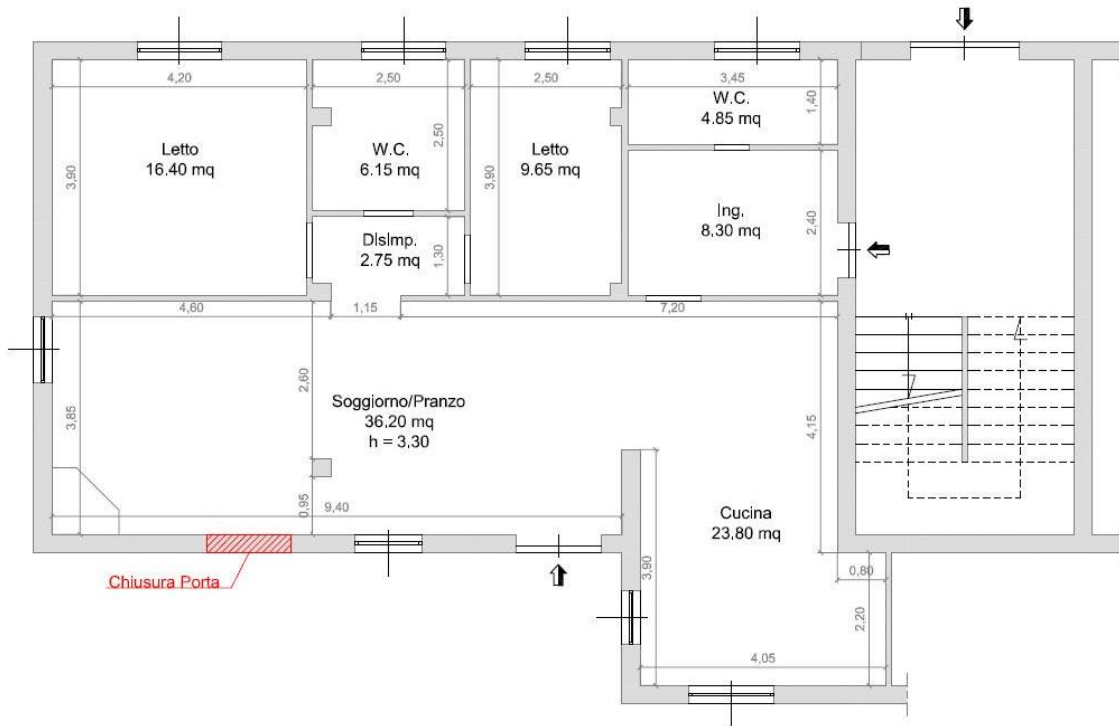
Planimetria Stato di fatto Foglio 46, p.lla 1235, sub 3.
